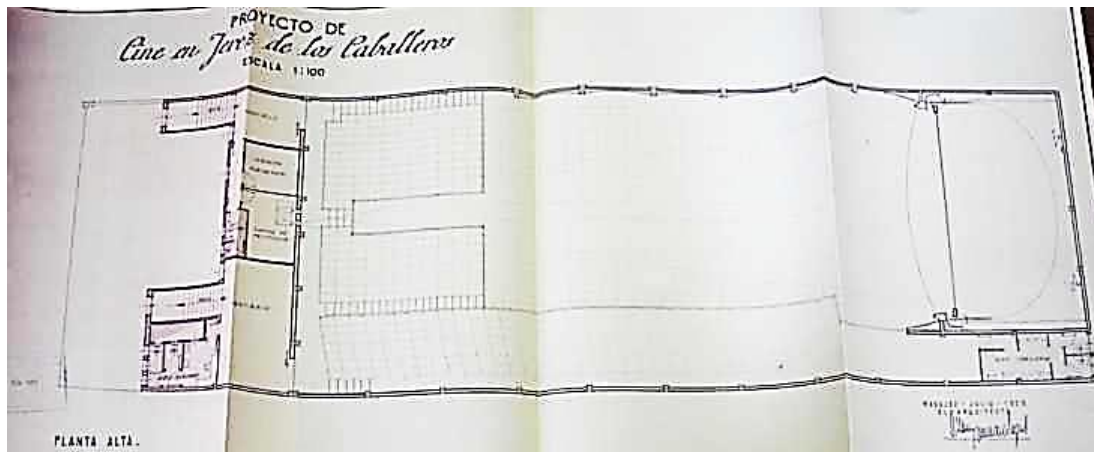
Plano de la planta primera del Cine Teatro Balboa (URGEL, M., 1959).
